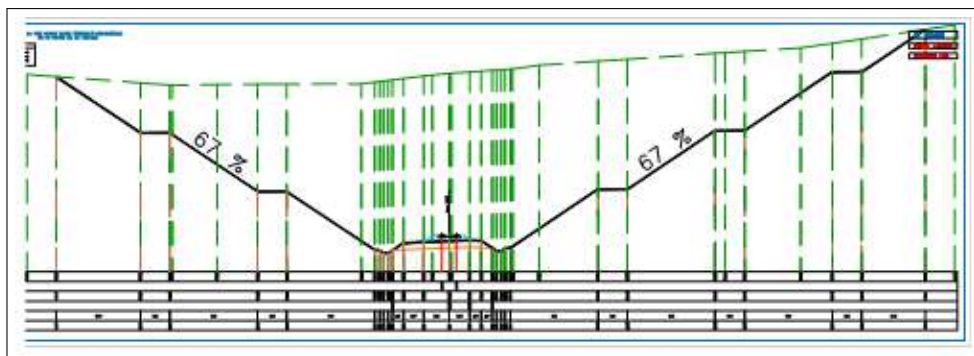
Profil en travers courant PK 05+000 (pente : 3H/2V)
